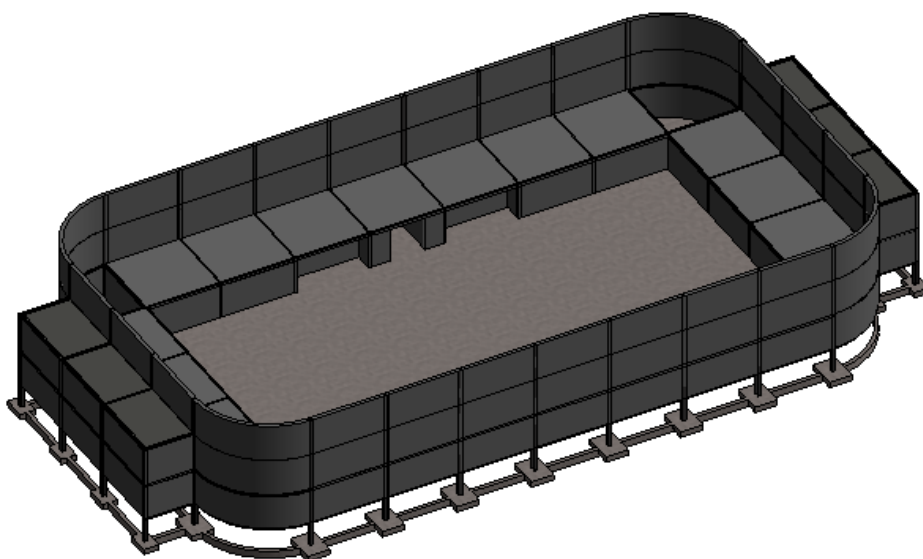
Vista 3D con la colocación de todos los techos y muros
